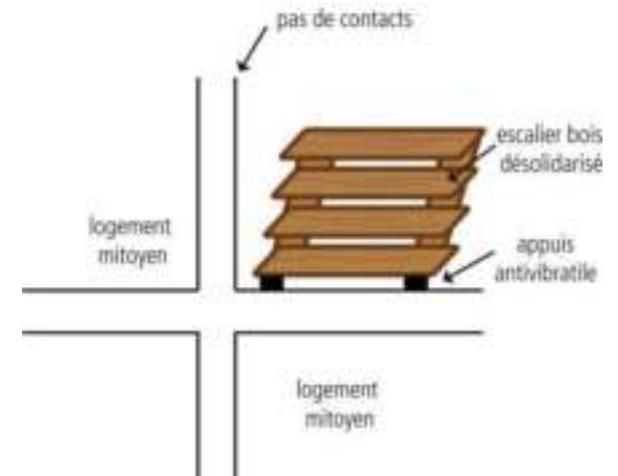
Escalier bois situé contre une paroi et/ou un plancher mitoyen au logement contigu
